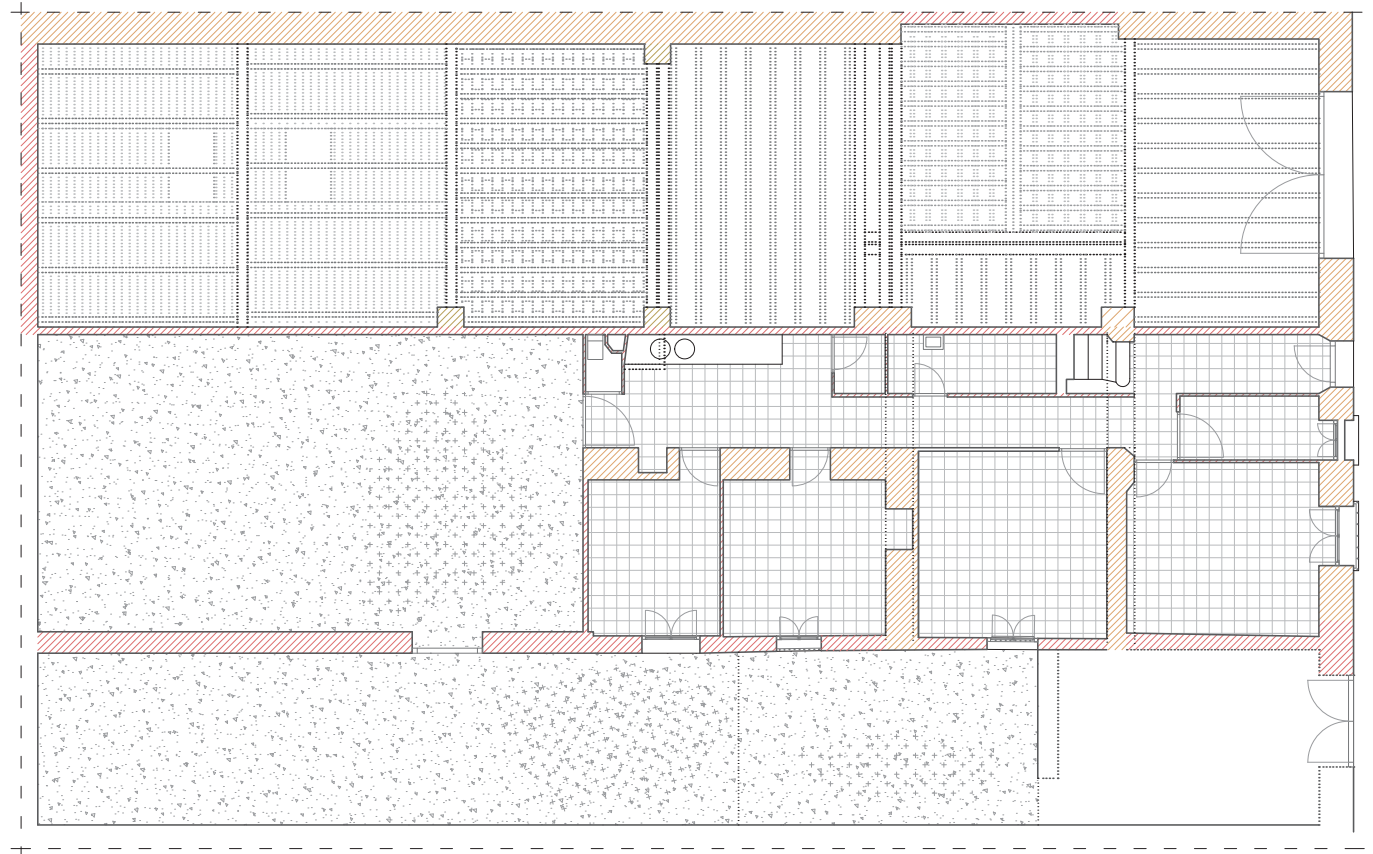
Planta baja (Fuente: elaboración propia)
